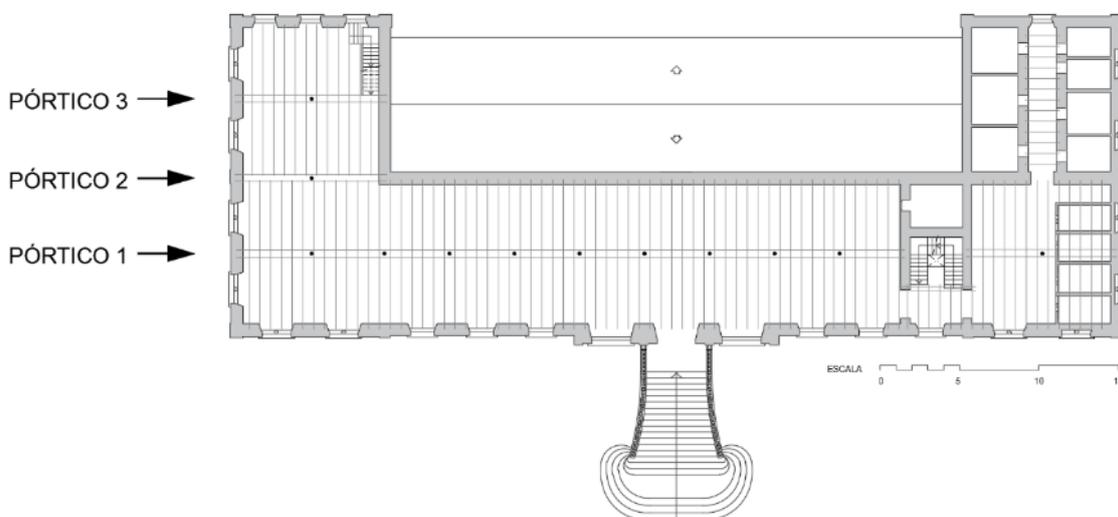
Esquema estructural. Pilares de planta primera y forjado de planta segunda.
